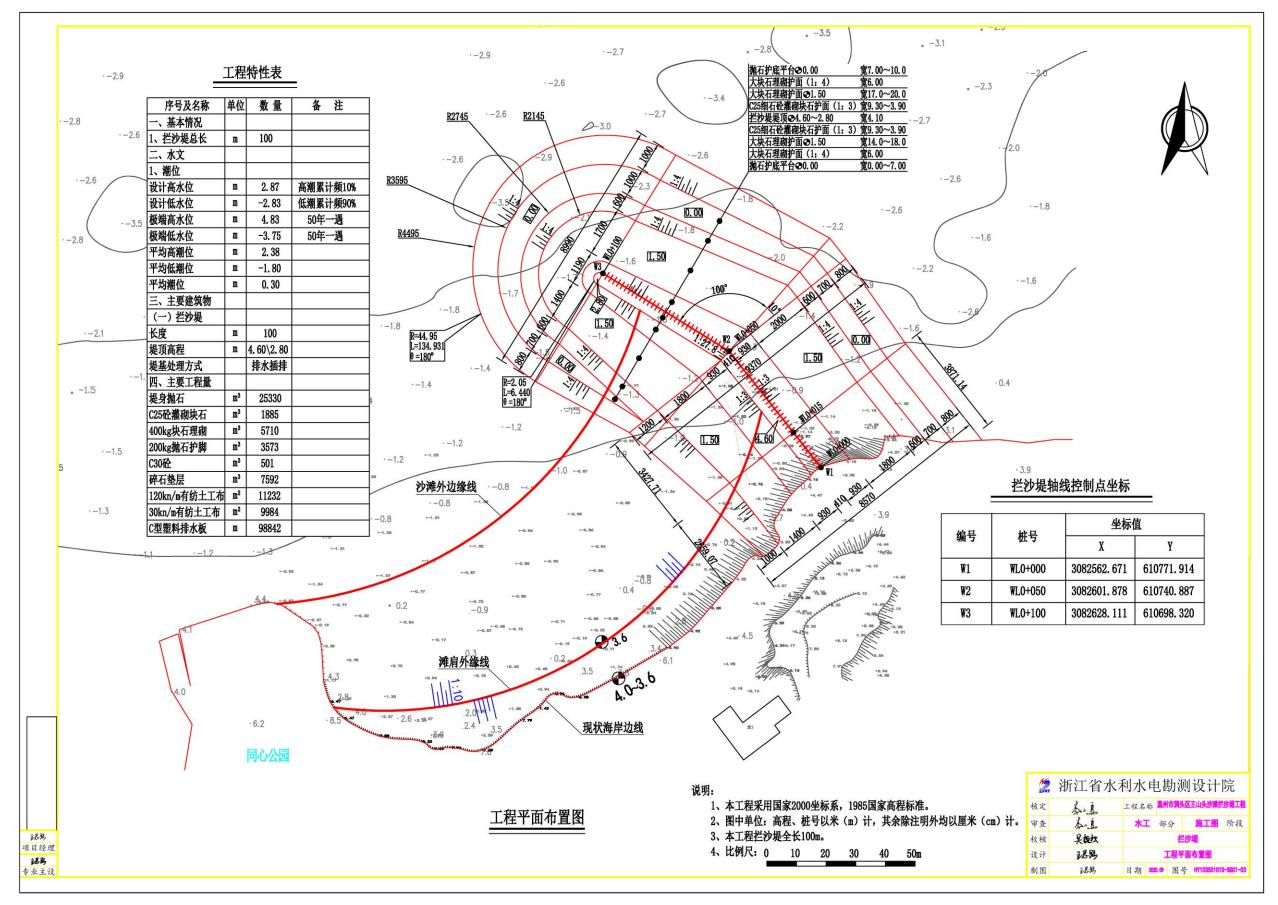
王山头沙滩建设工程拦沙堤平面布置图
